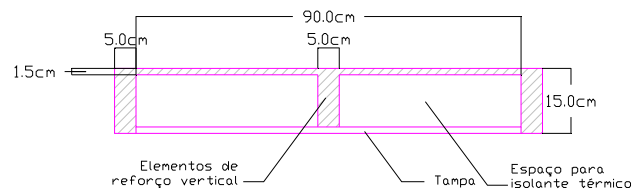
Corte transversal de um painel típico da segunda alternativa para o sistema construtivo.
